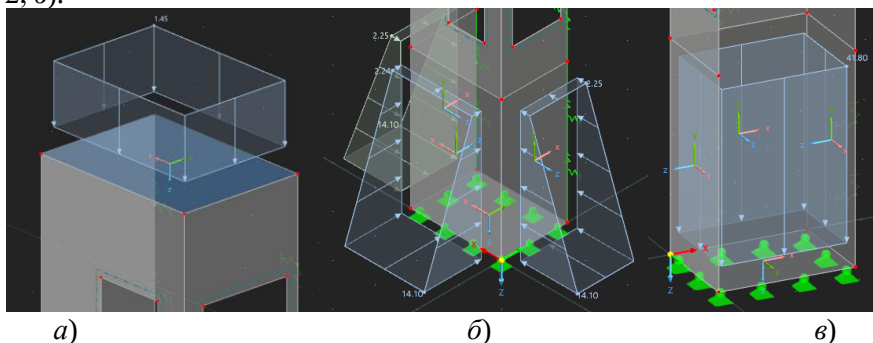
Схеми прикладання навантажень: а) на стінові конструкції від конструкцій покриття; б) на стінові конструкції, що межують з ґрунтом; в) на фундаментну плиту від конструкцій ліфту
